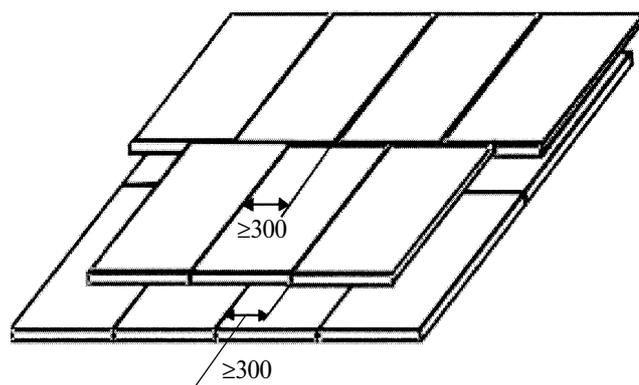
Схема укладки тепло- звукоизолирующих пенополистирольных плит
